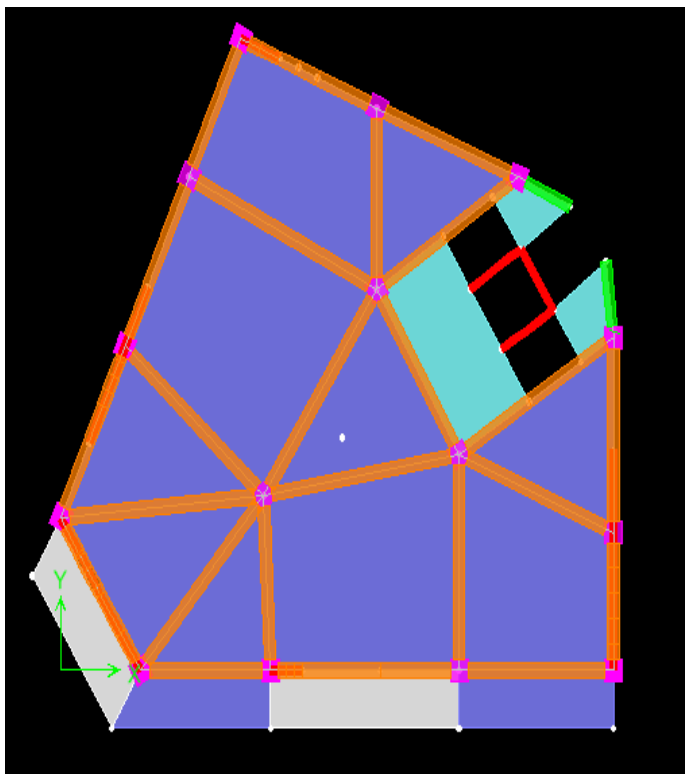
Vue en plan des éléments structuraux d'un étage
